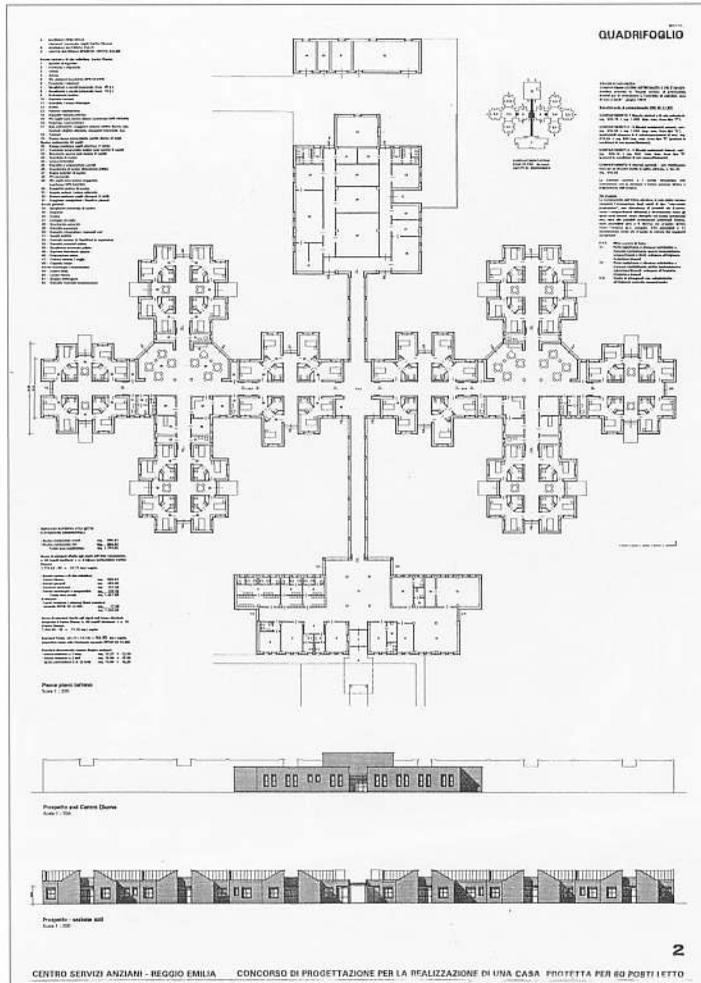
> Tavola di concorso: planimetria generale e prospetti
